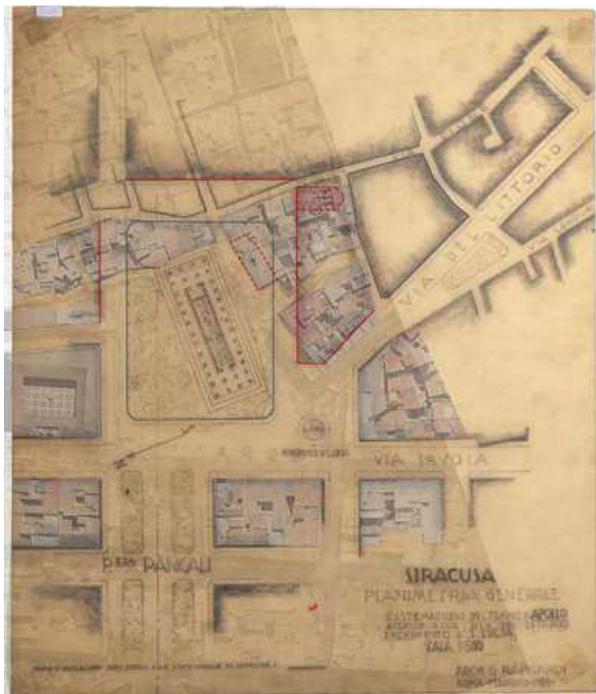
Siracusa, Planimetria di progetto della sistemazione del tempio di Apollo dell'architetto Gaetano Rapisardi (rielaborazione dell'autrice, 2023).
